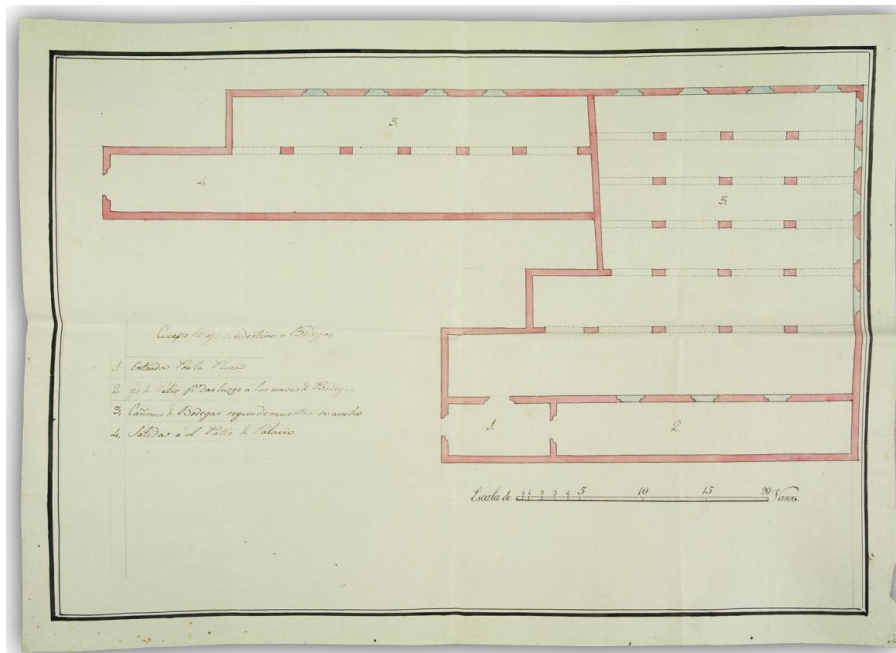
Proyecto para convertir la planta baja del palacio en bodegas (1828).
